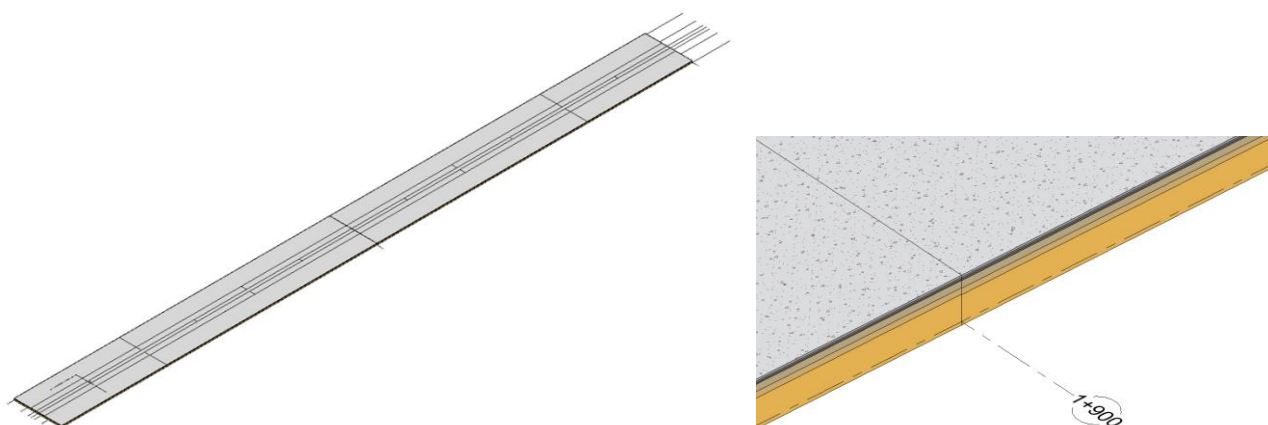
Vista superior (à esquerda) e pormenor de corte (à direita) do troço modelado
